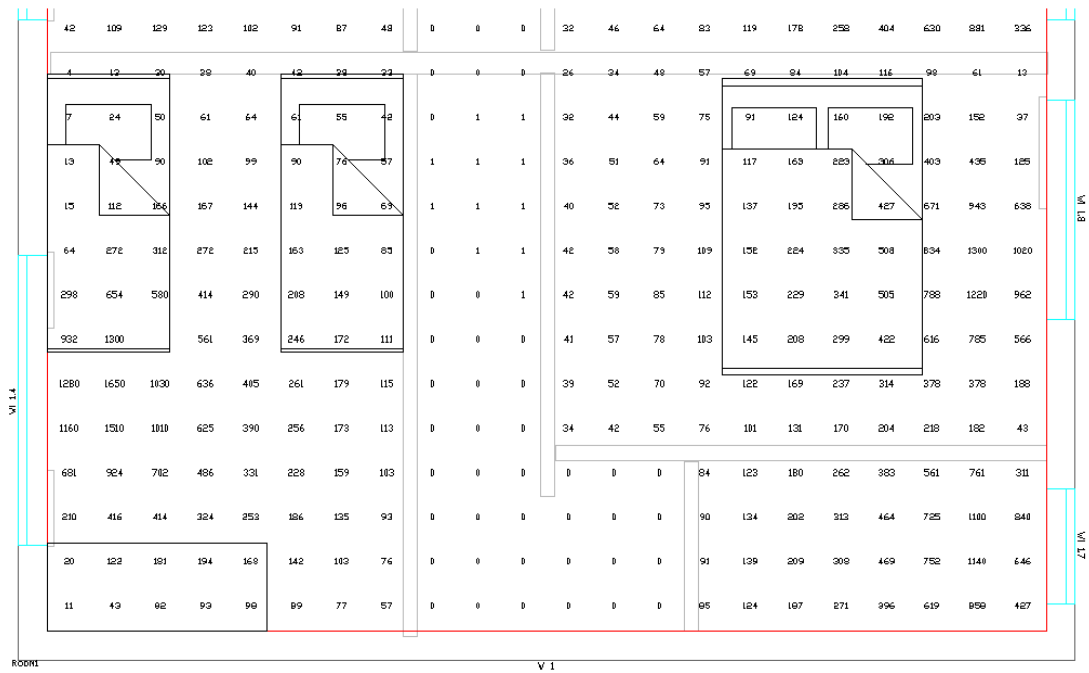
Distribuição da iluminância ponto a ponto no 1º pavimento (em lux).
